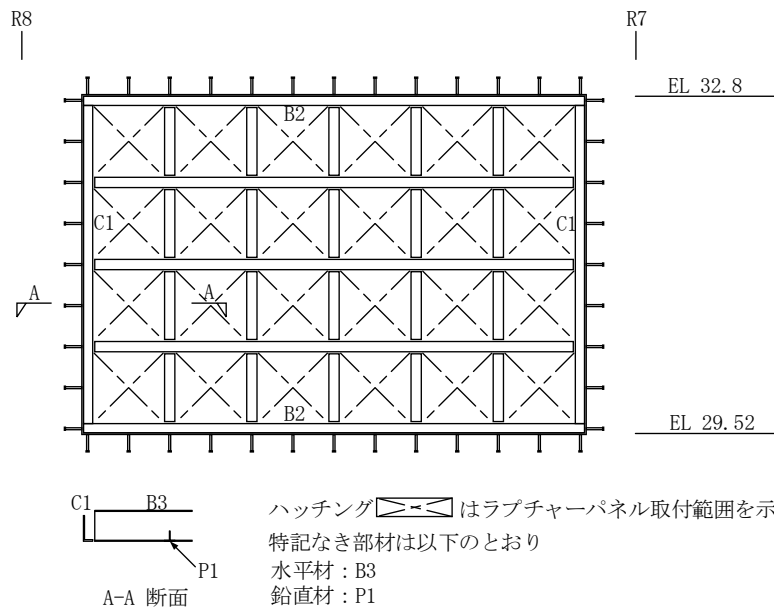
(3) 部材の配置 (MS トンネル室 BOP No. 3) (単位：m)
